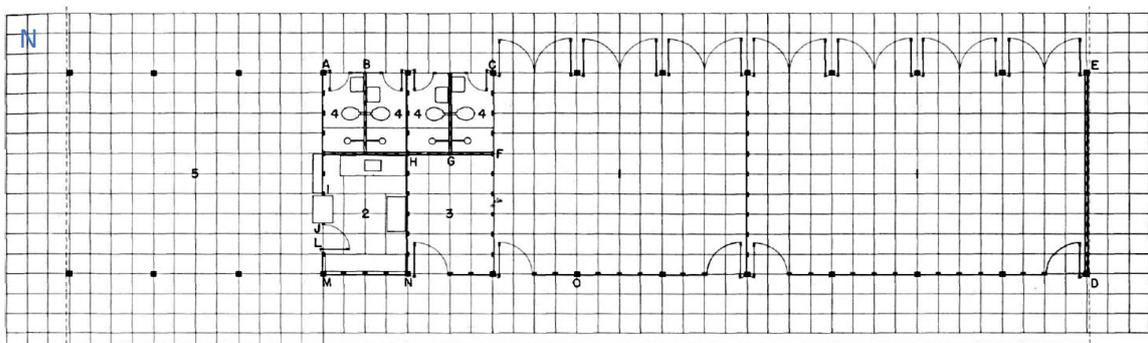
Planta de distribución del Prototipo de argamasa armada
